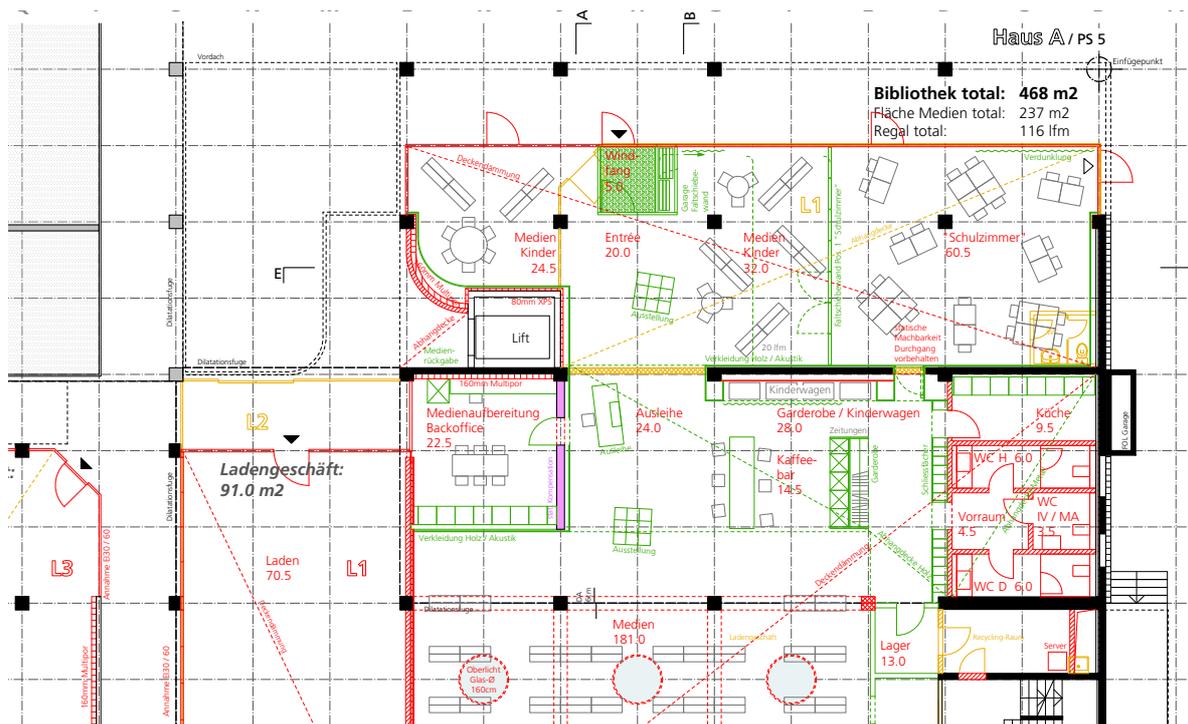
Ausschnitt Platzgeschoss Baugenossenschaft Hochwacht Zürich (Plan: Choffat + Filipaj Architekten GmbH)
